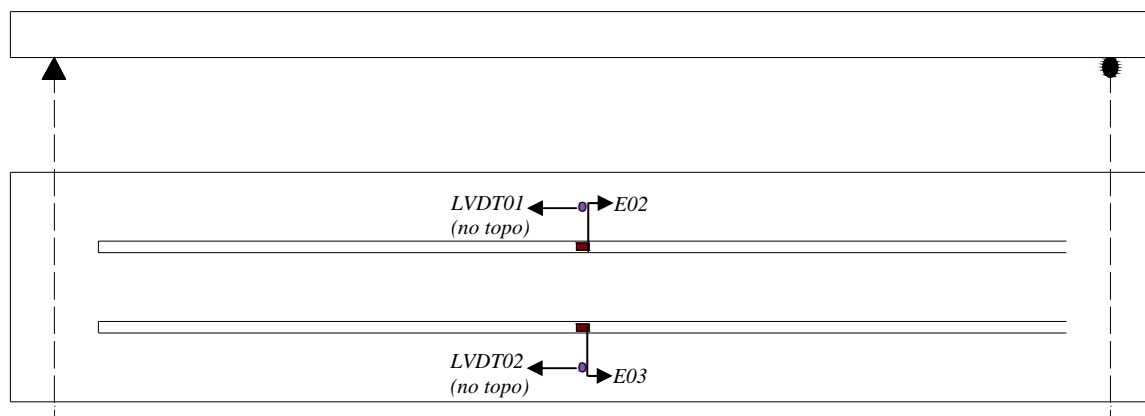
Esquema de instrumentação das vigas ensaiadas com carregamento estático na segunda etapa da pesquisa.
